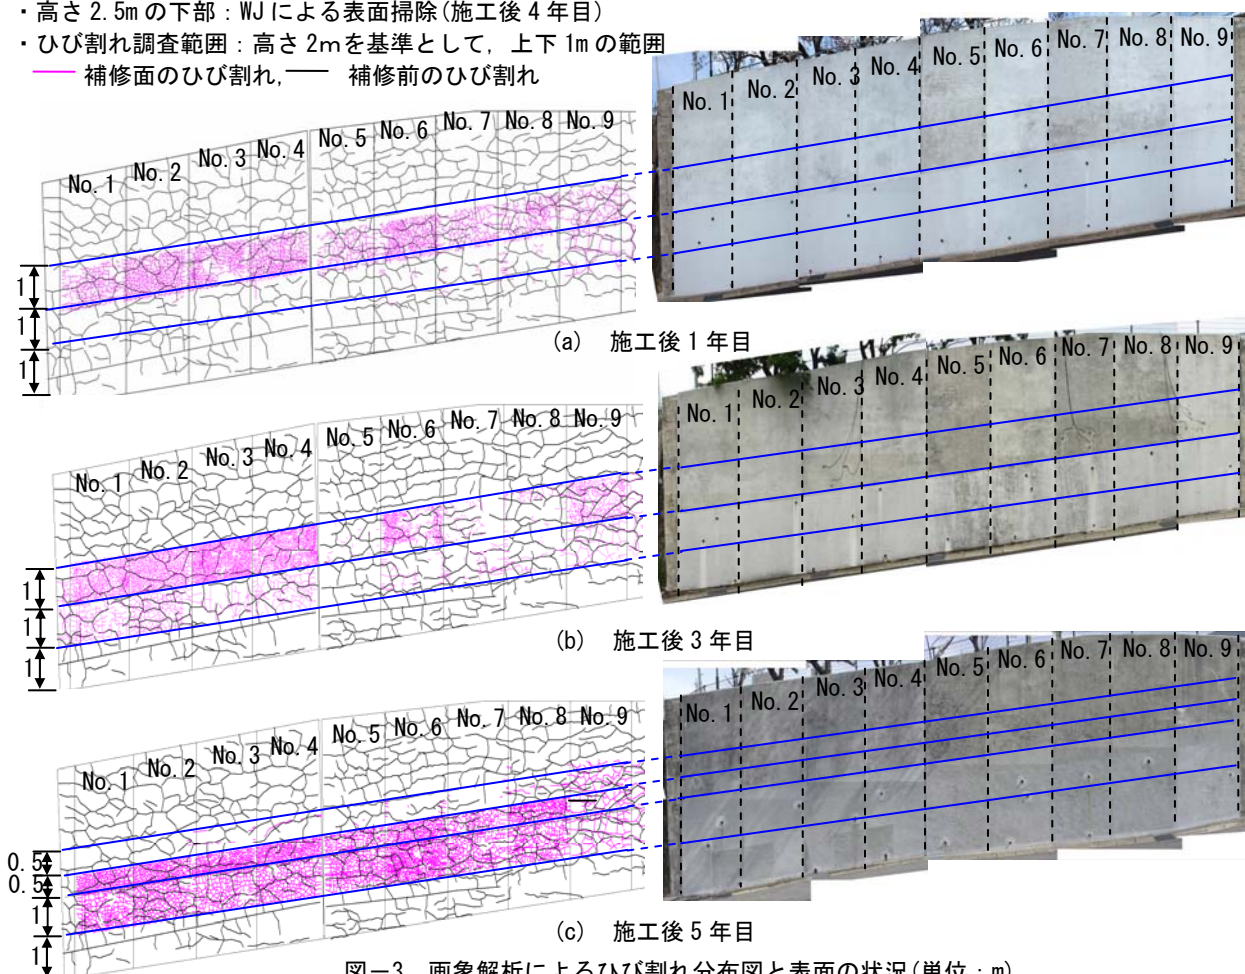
画像解析によるひび割れ分布図と表面の状況 (単位 : m)
